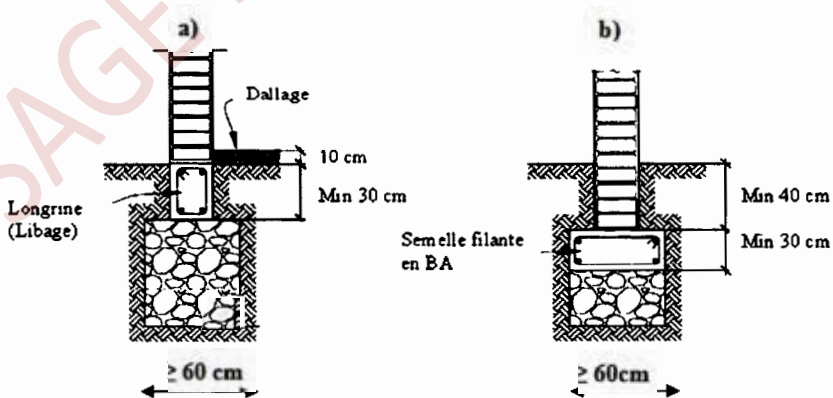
Fondations: a) Fondation en maçonnerie de pierres et longrine en BA; b) Semelle filante en BA
